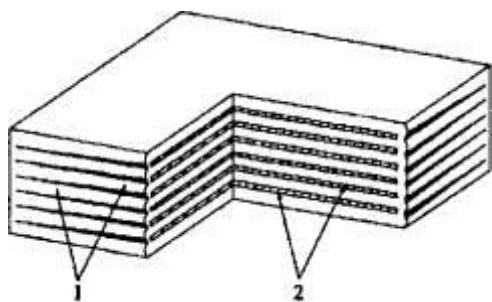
Нормальный вид боковых поверхностей резиновой опорной части под нагрузкой:
